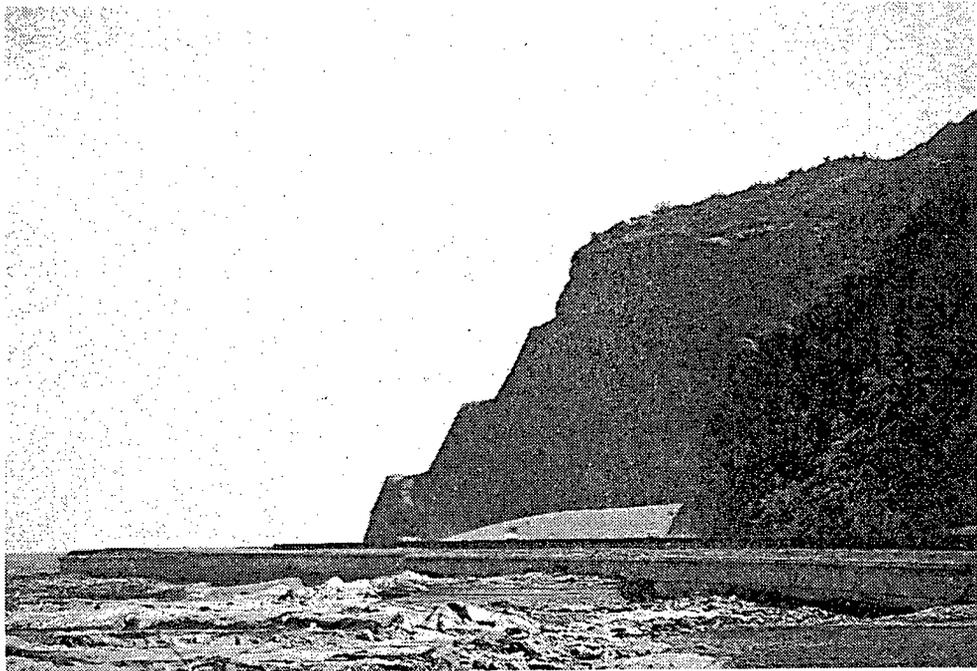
PROFIL DE LA COUPE DE TROIS PALIERS LE LONG DE LA ROUTE 132 ENTRE LA MARTRE ET MARSOUI .
